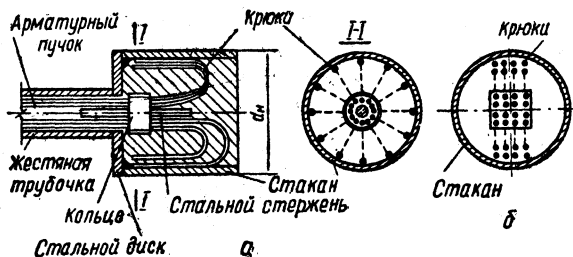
Анкеровка арматуры пучков с помощью крюков и стальной трубы при расположении проволок: а — концентрично; б — параллельно со смещенными крюками.
